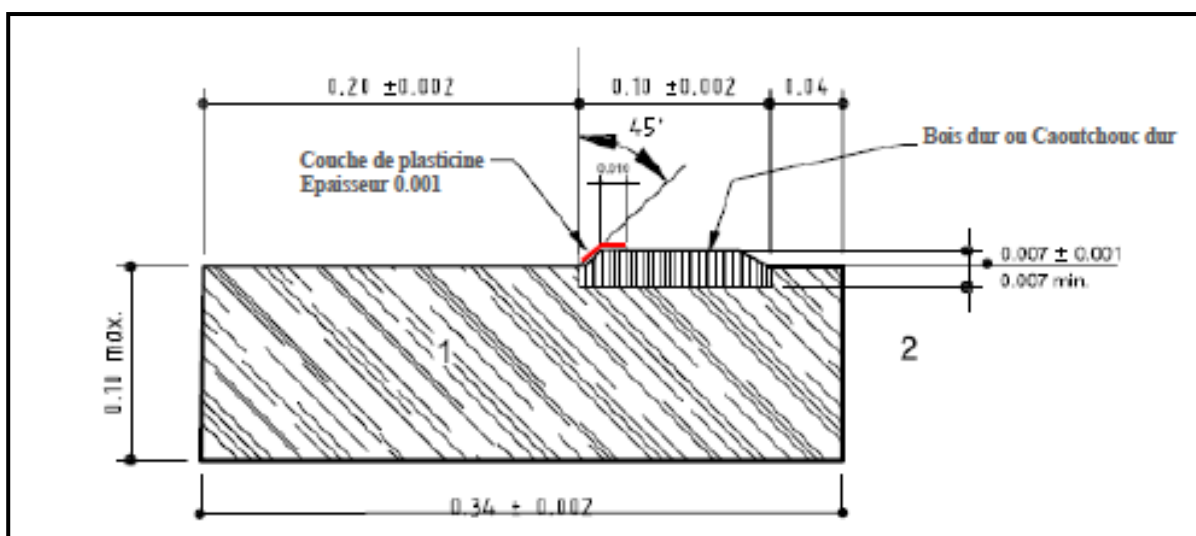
exemple d'une planche d'appel incorporant la planche de plasticine (dimensions en m)
